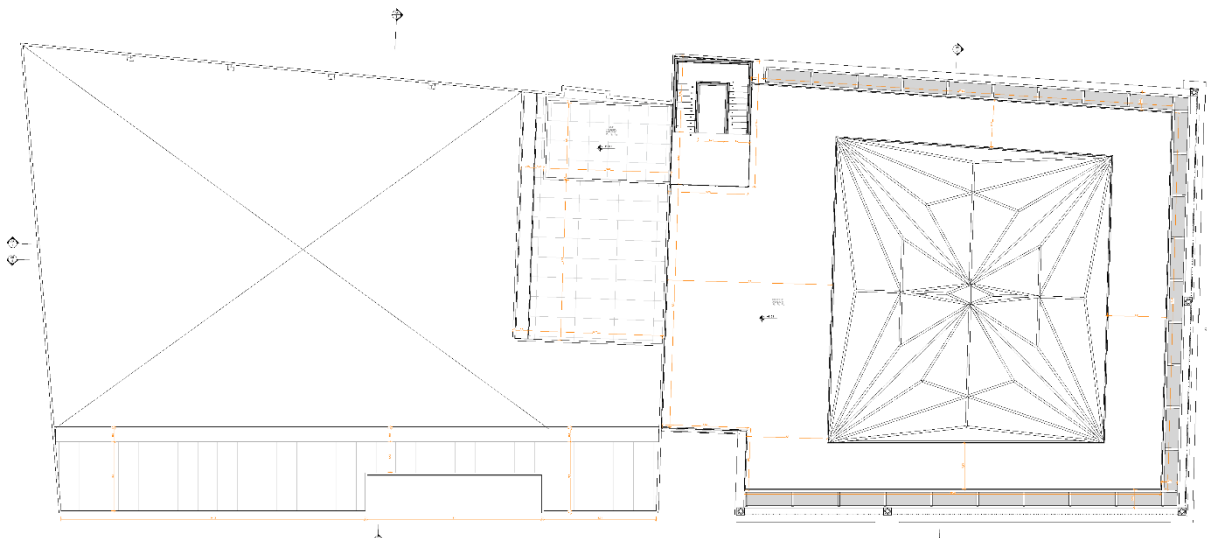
Planta Baixa, Terraço, Fonte: Elaboração Autoral, 2023
